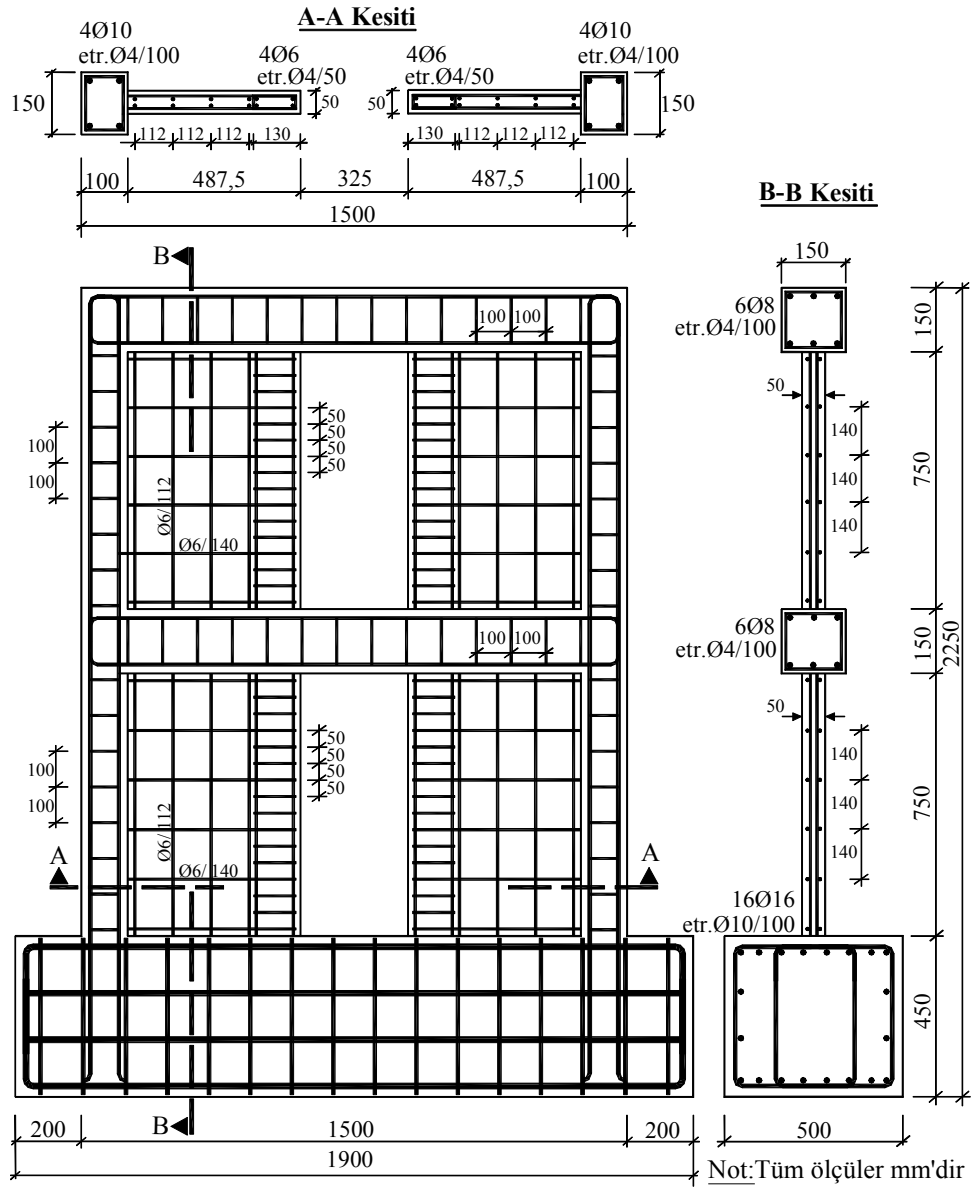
Denei Elemanı-6'nın filiz donatısı detayı
